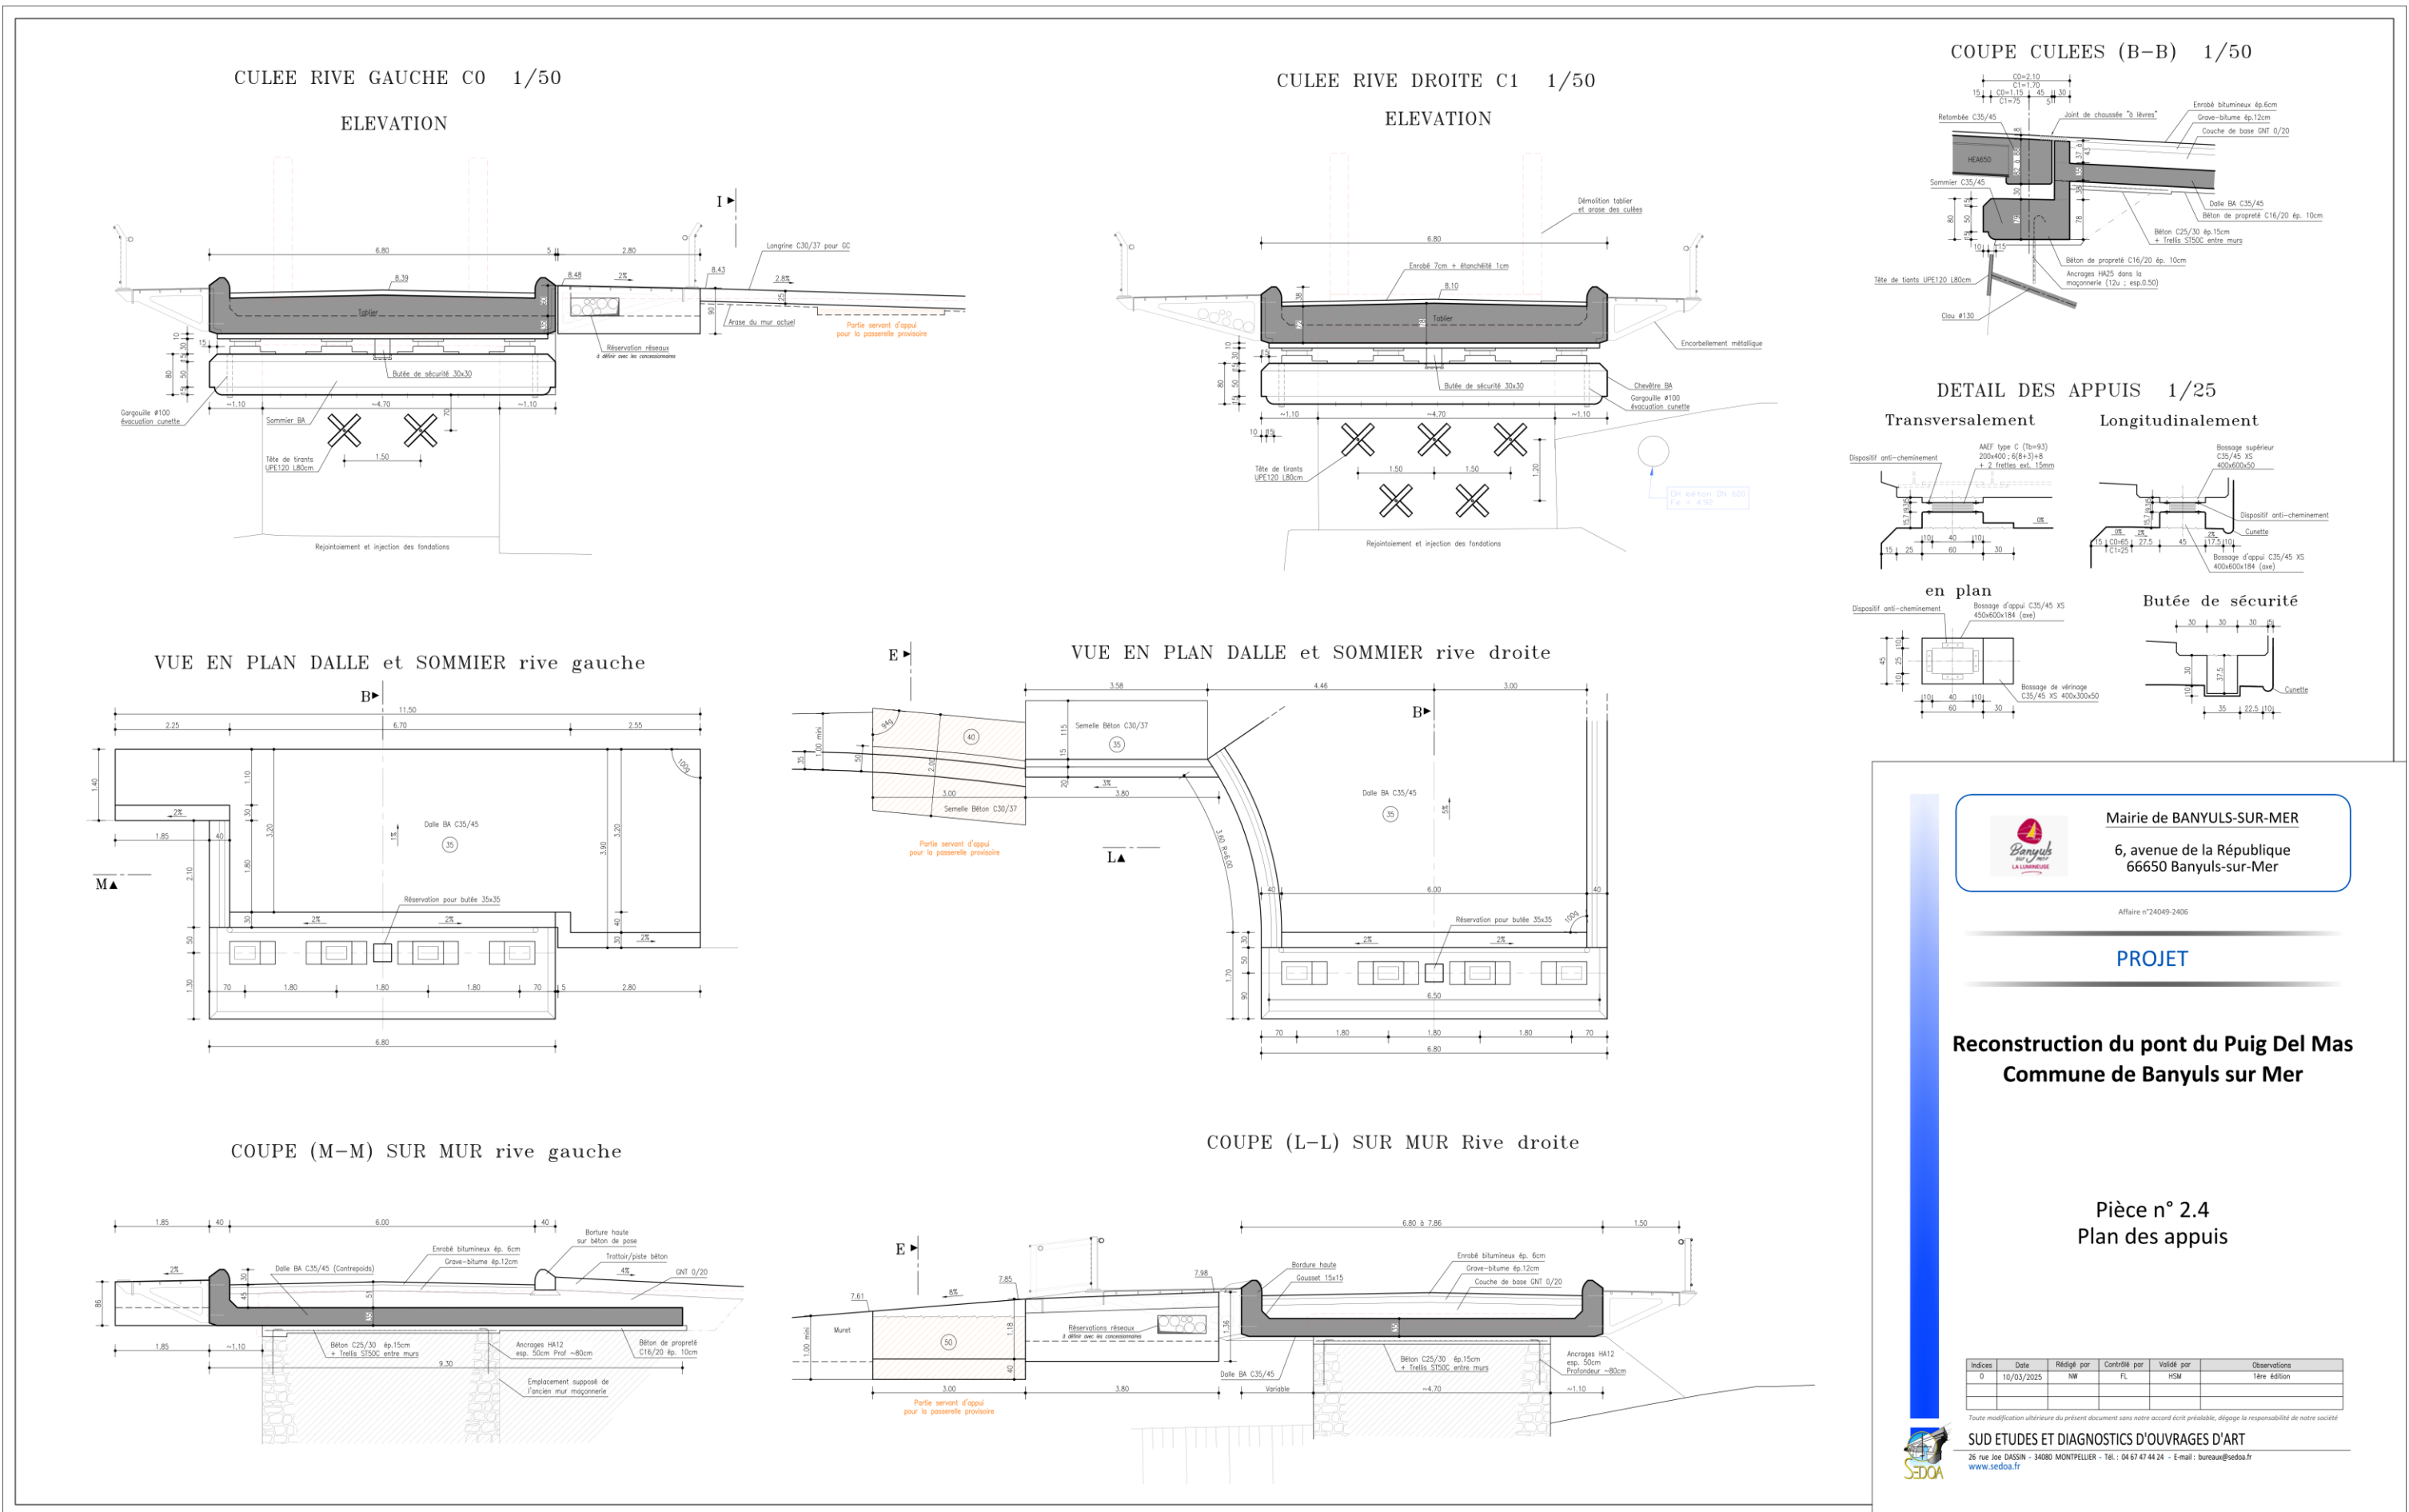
Vue en plan et en coupes du projet (source : SEDOA, DCE, mai 2025)
